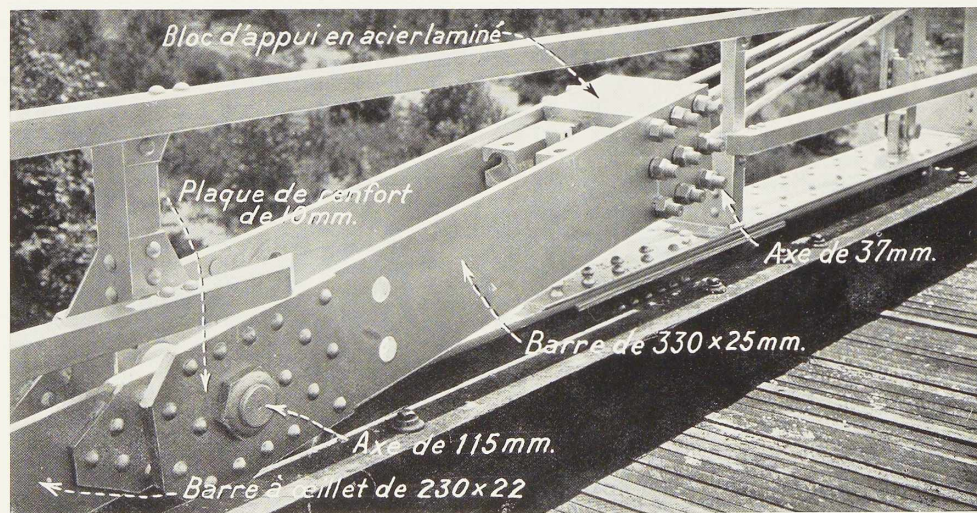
Fixation des câbles aux barres qui sont ancrées aux poutres de rigidité.
